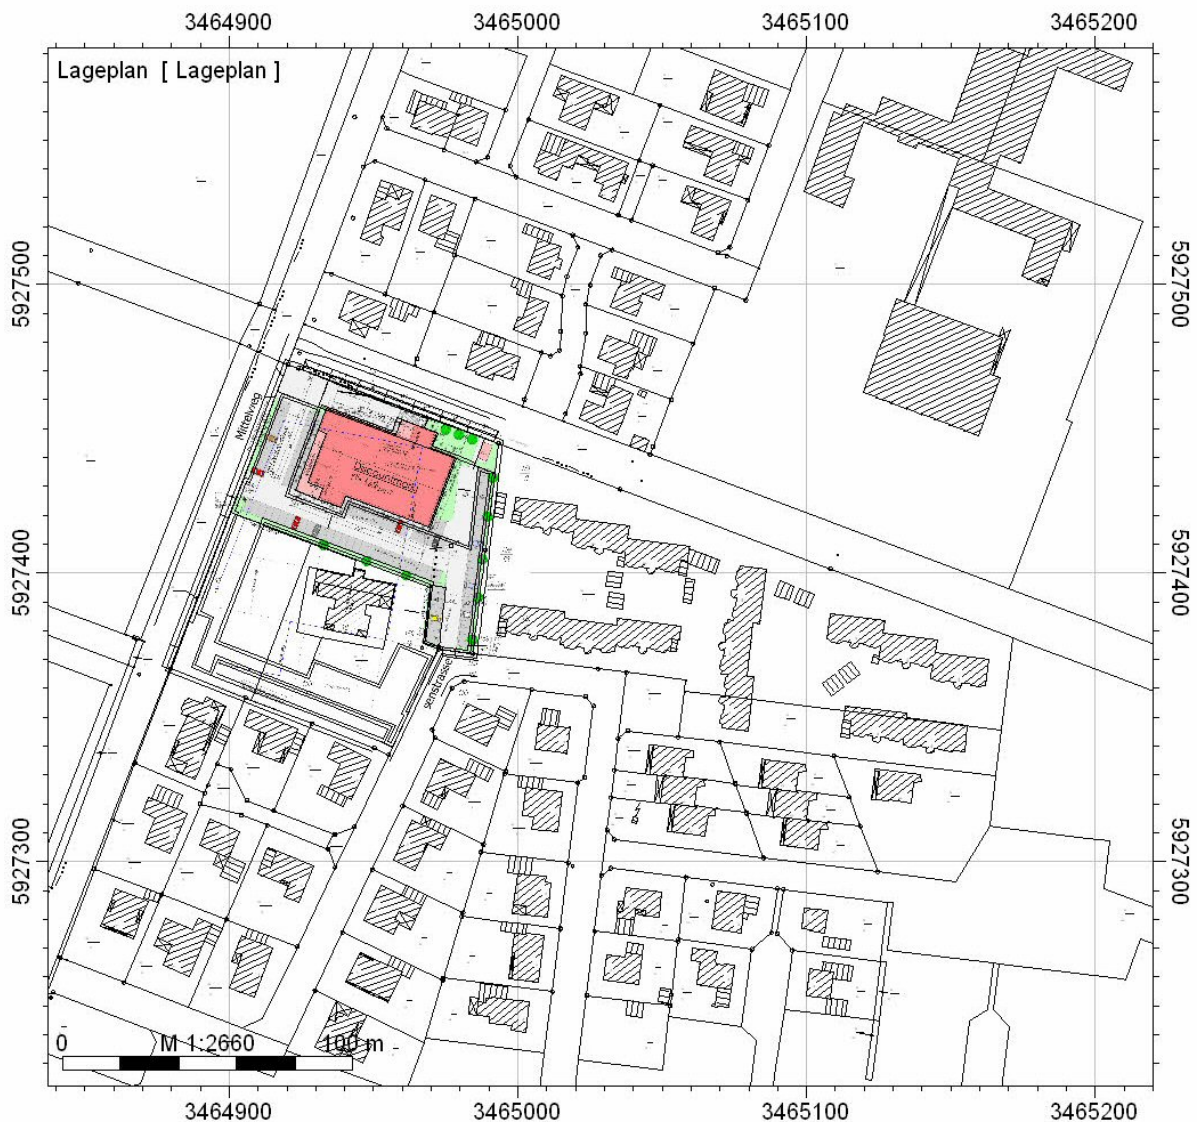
Lageplan mit der Umgebung des geplanten Discountmarktes.
